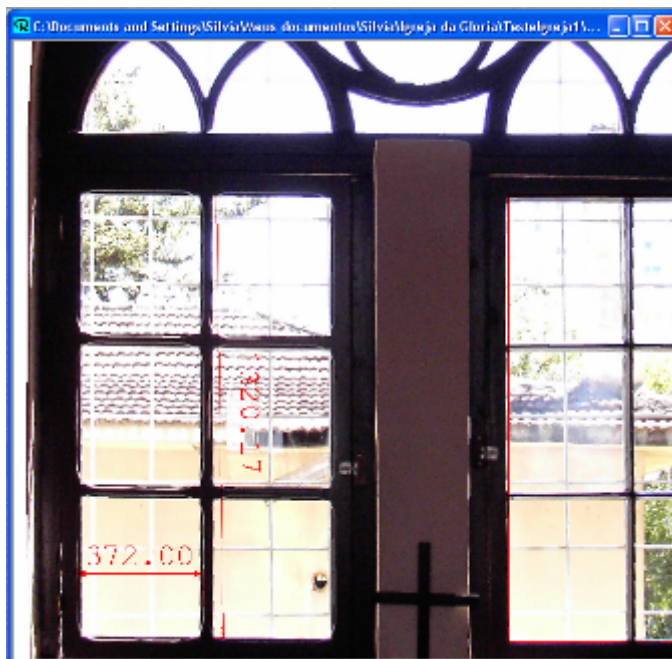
Conferencia das medidas levantadas em campo da janela ao lado. Fonte: Rollei MSR Plan, 2006.
